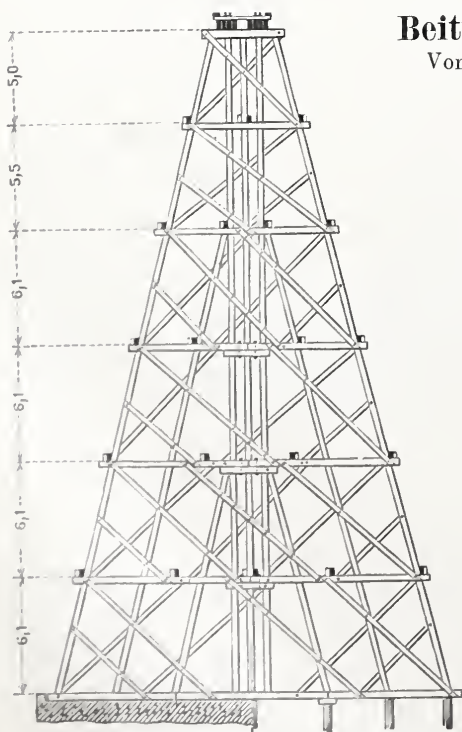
Längenschnitt einer sechs Stockwerk hohen Holzbrücke der Denver-Nordwest und Pacific-Bahn.
